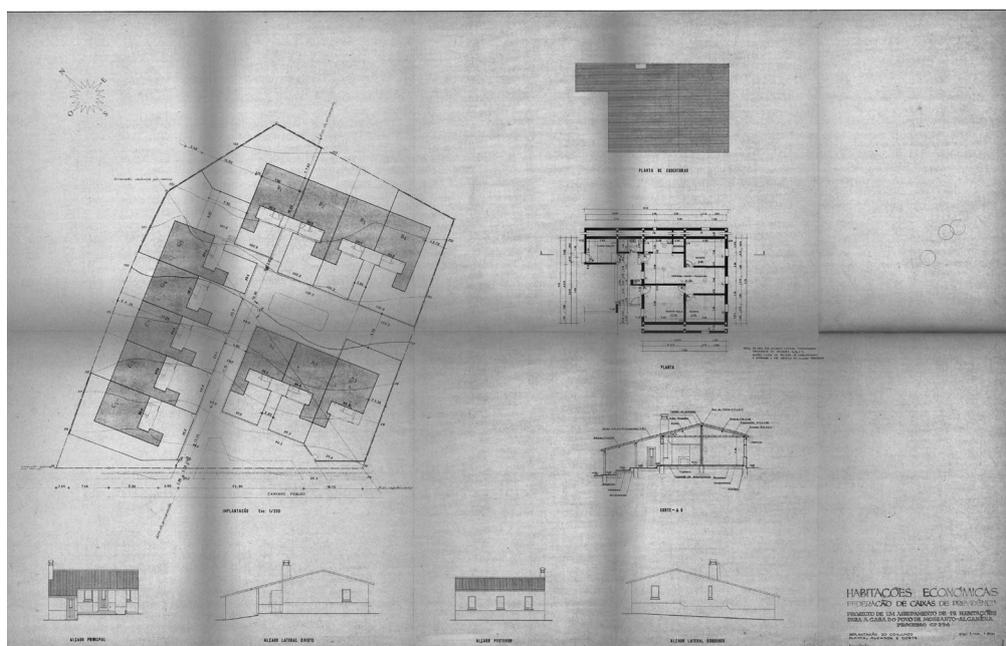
Projeto: implantação do conjunto, planta, alçados e corte
